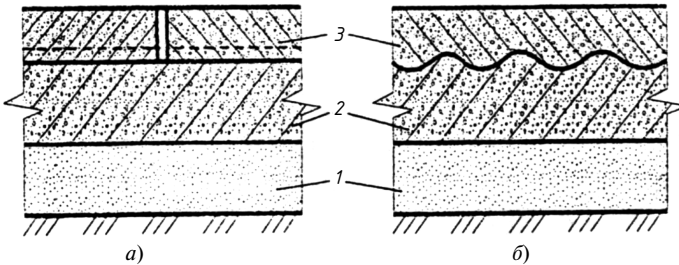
Сборно-монолитное цементобетонное покрытие: *а* — поперечный разрез; *б* — продольный разрез; *1* — основание; *2* — нижний (монолитный) слой покрытия; *3* — верхний (сборный) слой покрытия
